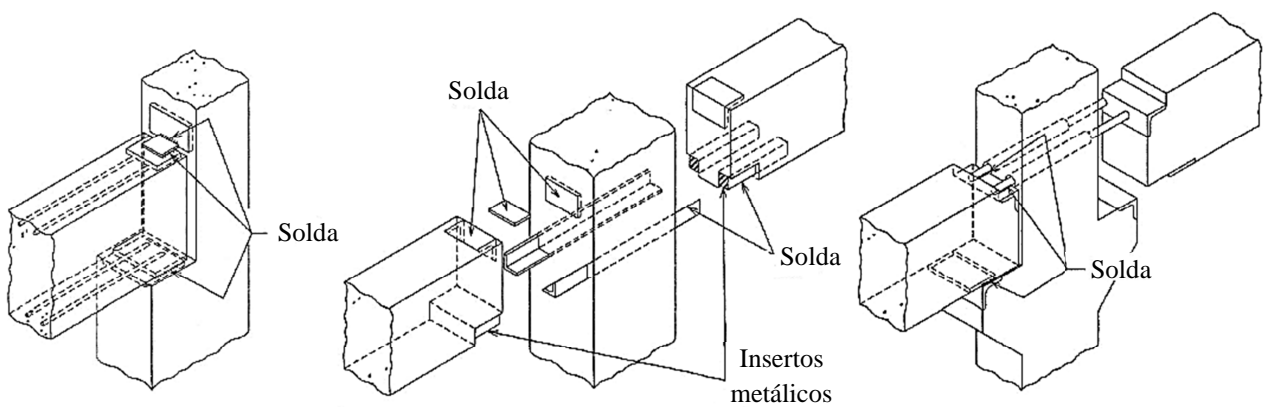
Ligações viga - pilar rígidas com solda [EL DEBS (2000)].
